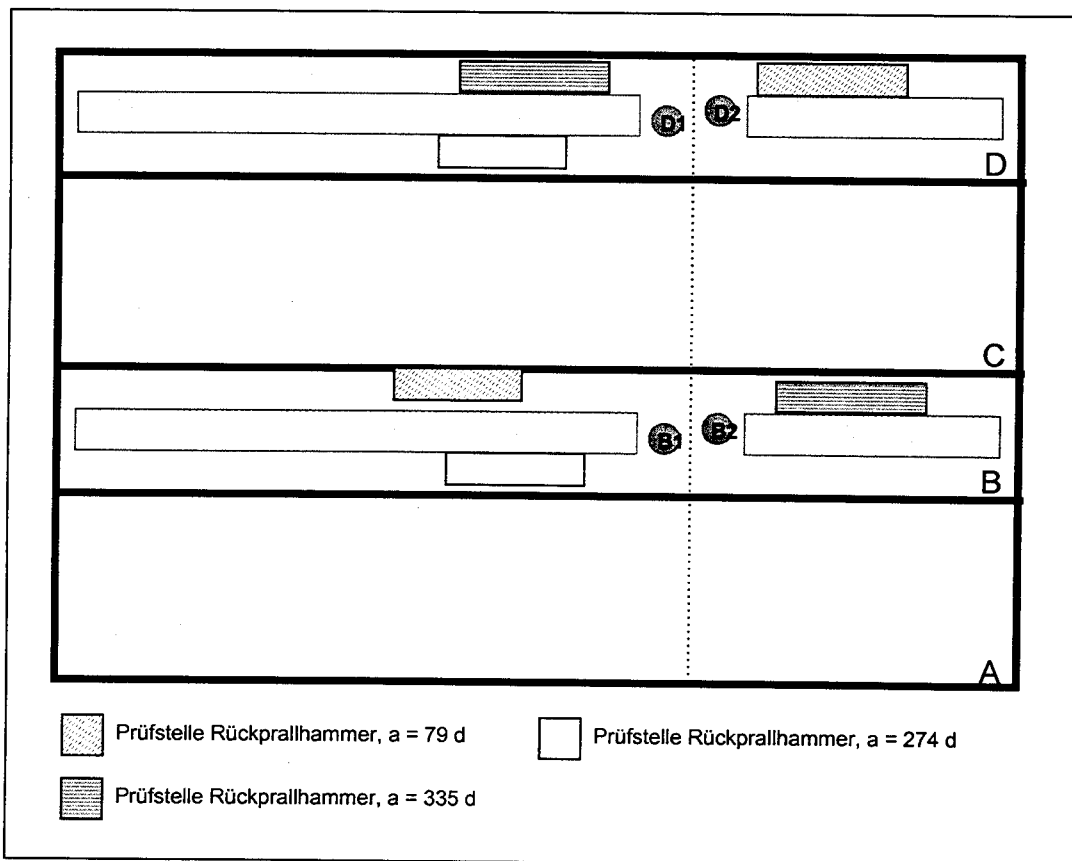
Lage der Prüfflächen am Betonkörper 16
